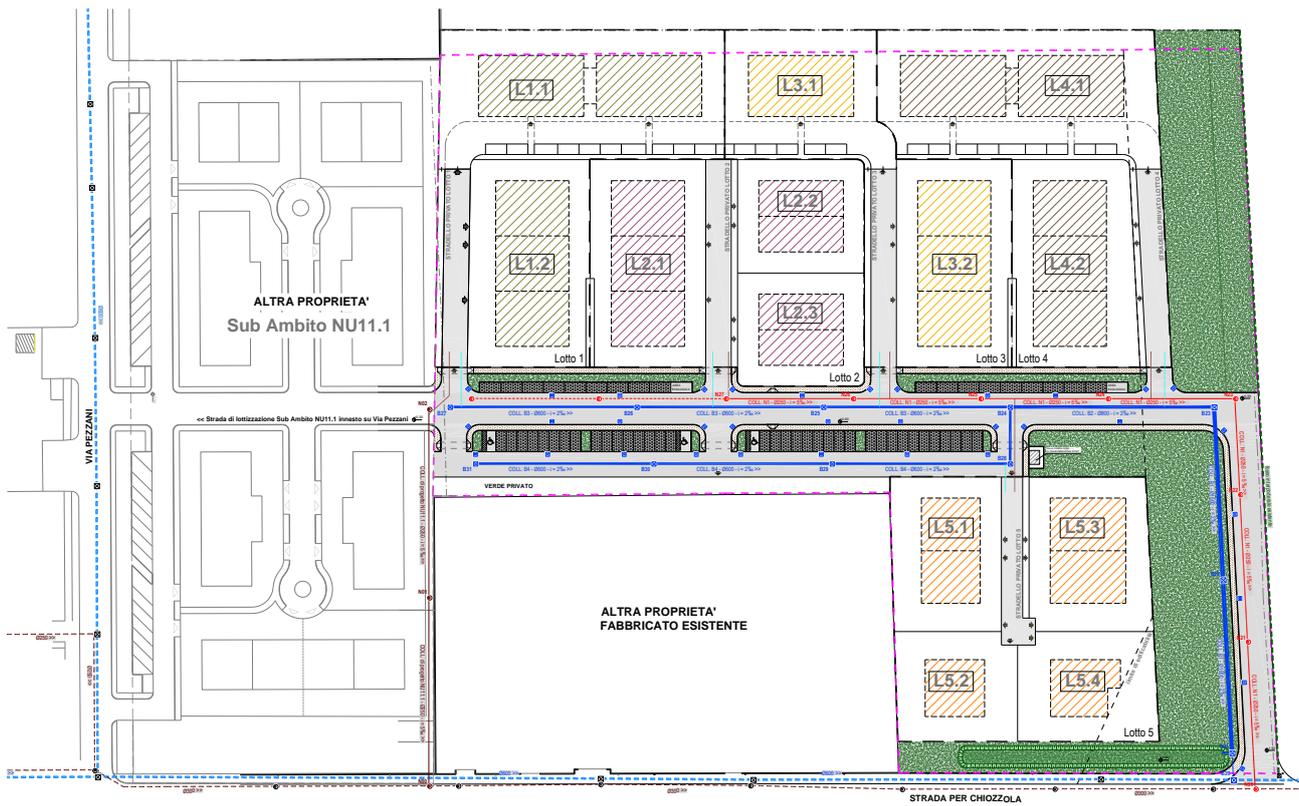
Planimetrica Reti di progetto (cfr. elab. PUA 04)
